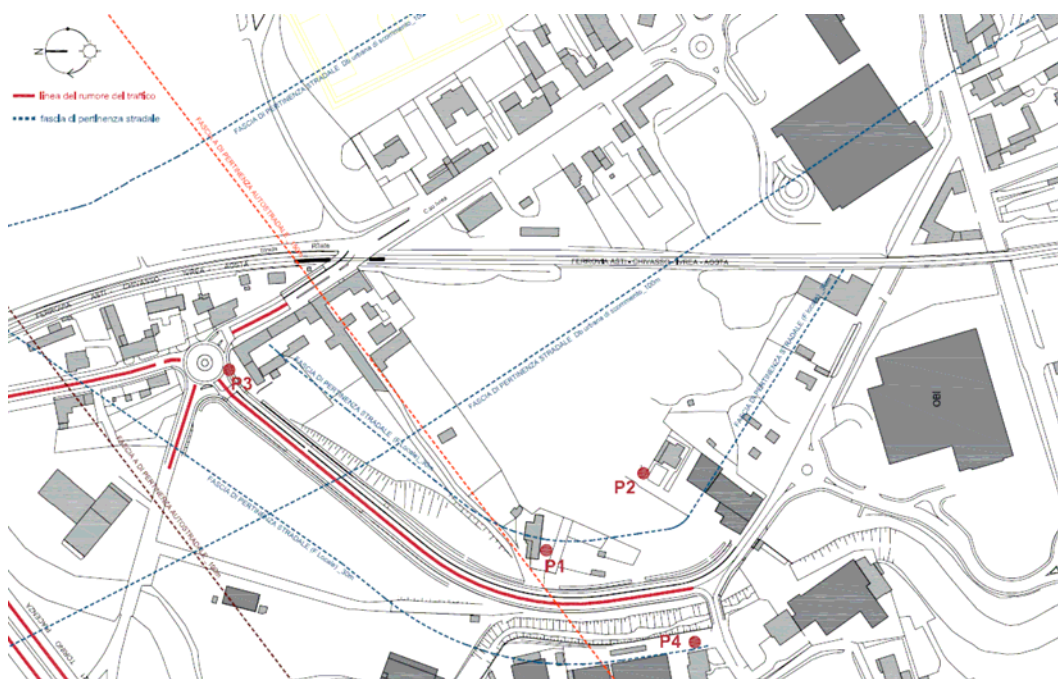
Tracciato della futura strada ed indicazione delle fasce di pertinenza delle singole infrastrutture
